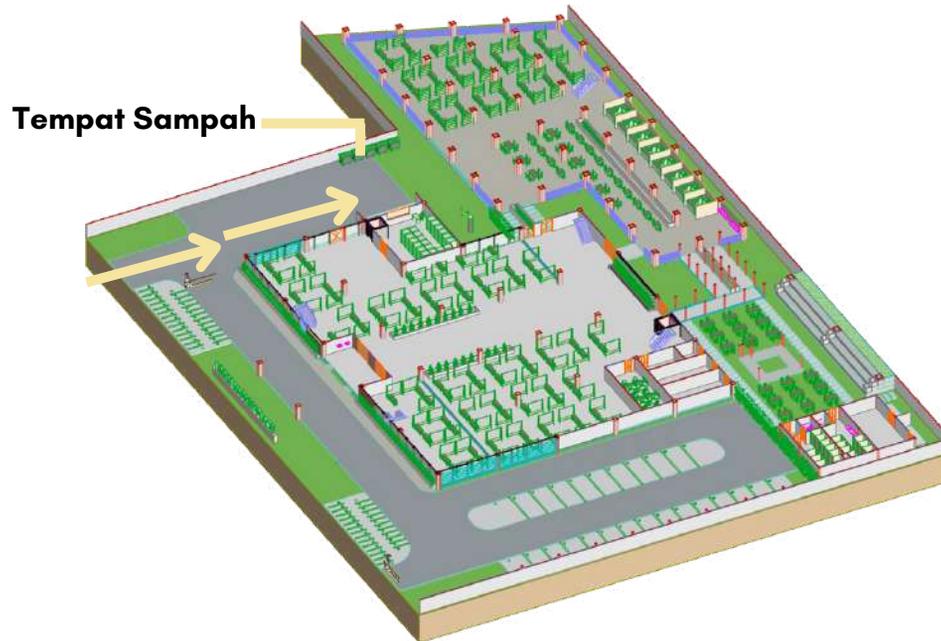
Denah bangunan Foodcourt Lt 1
